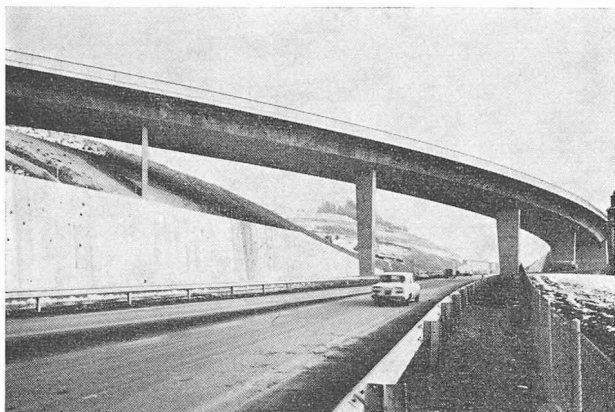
Vue d'ensemble de l'ouvrage prise dans la direction de Montreux.
